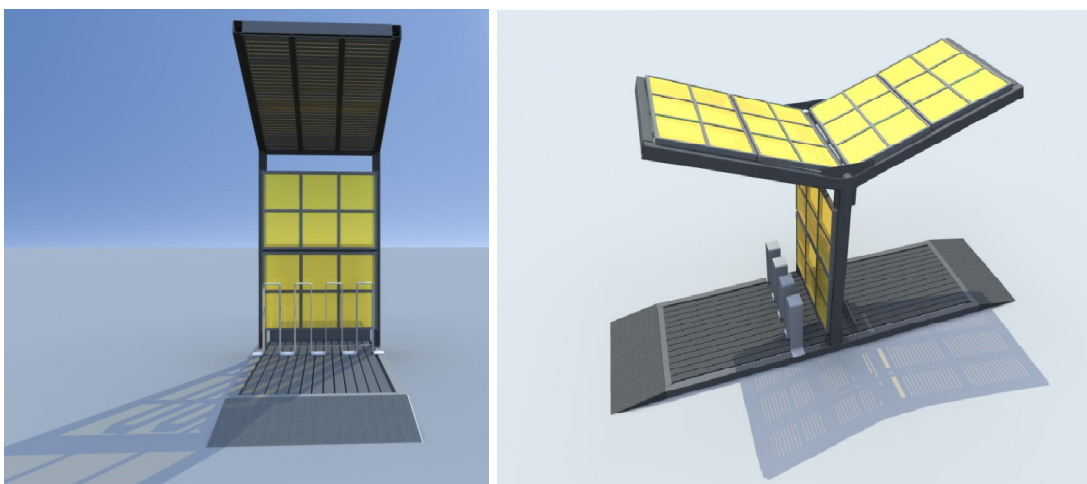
Vista frontale e assonometrica della struttura di un elemento della pensilina con i moduli LSC
